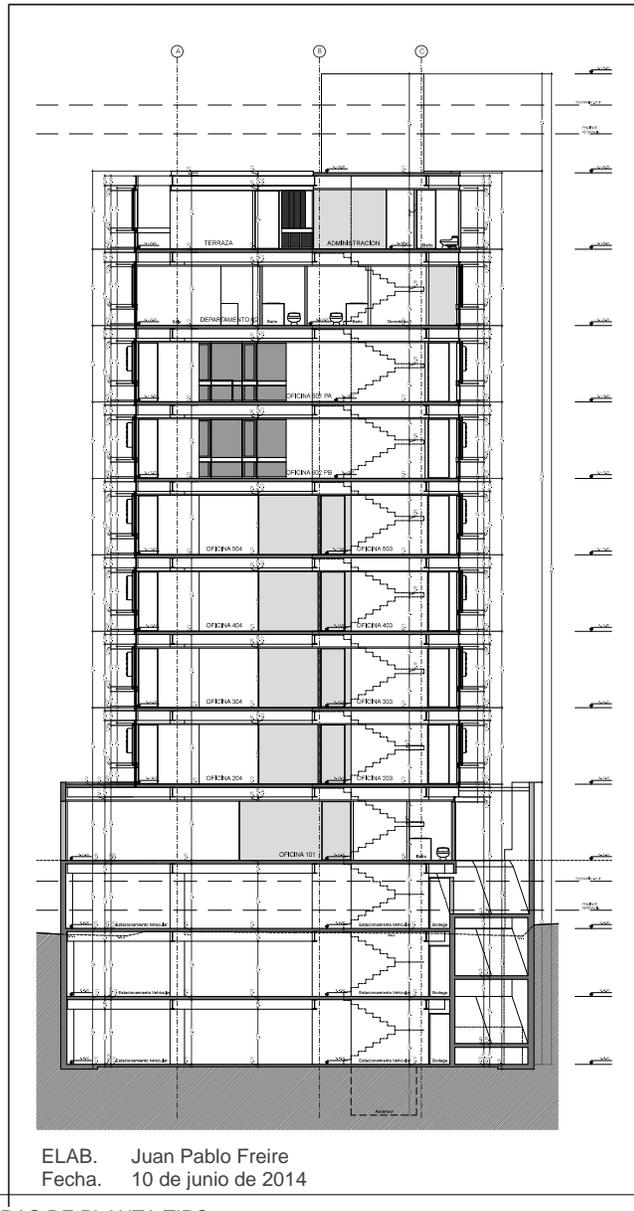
ALTURAS DE PLANTA TIPO
